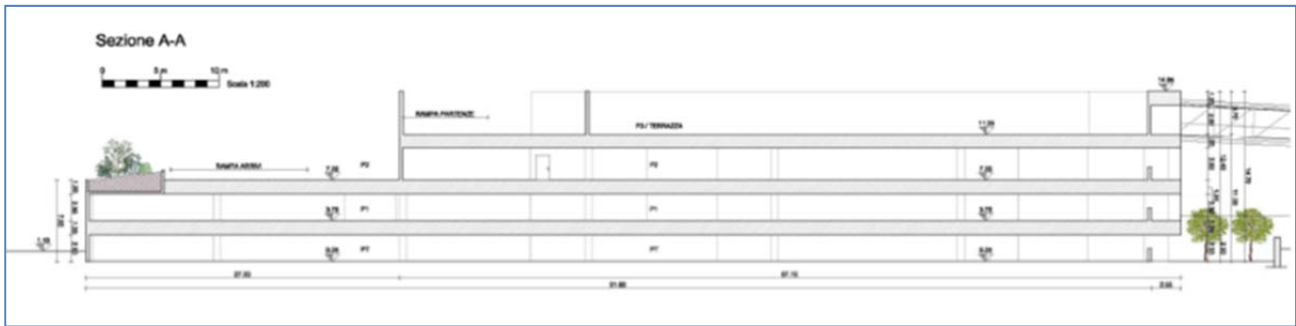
Sezione trasversale del parcheggio multipiano.
